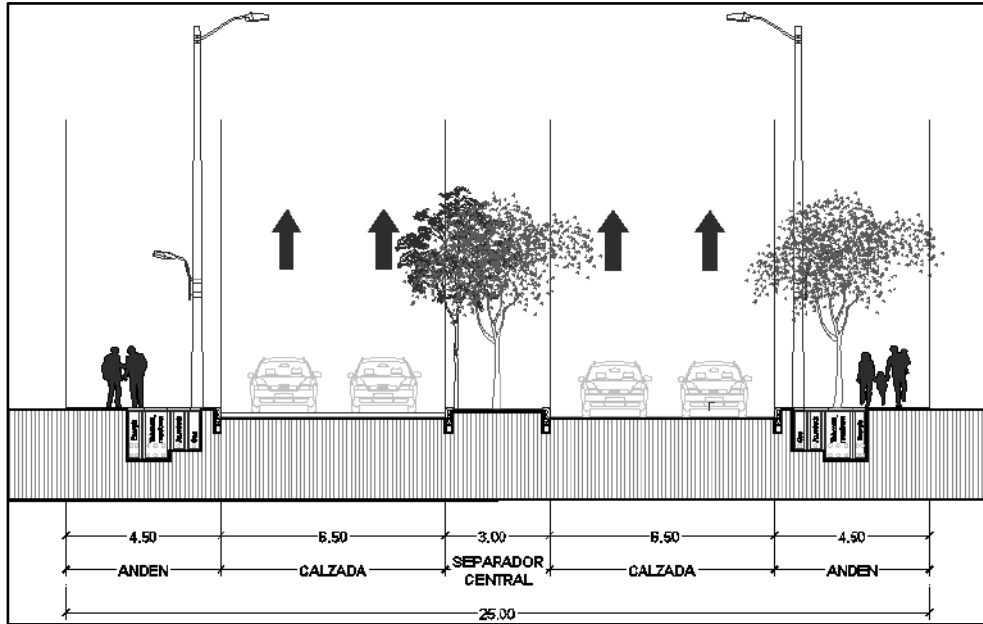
Perfil típico vía tipo V4 (Calle 7)
